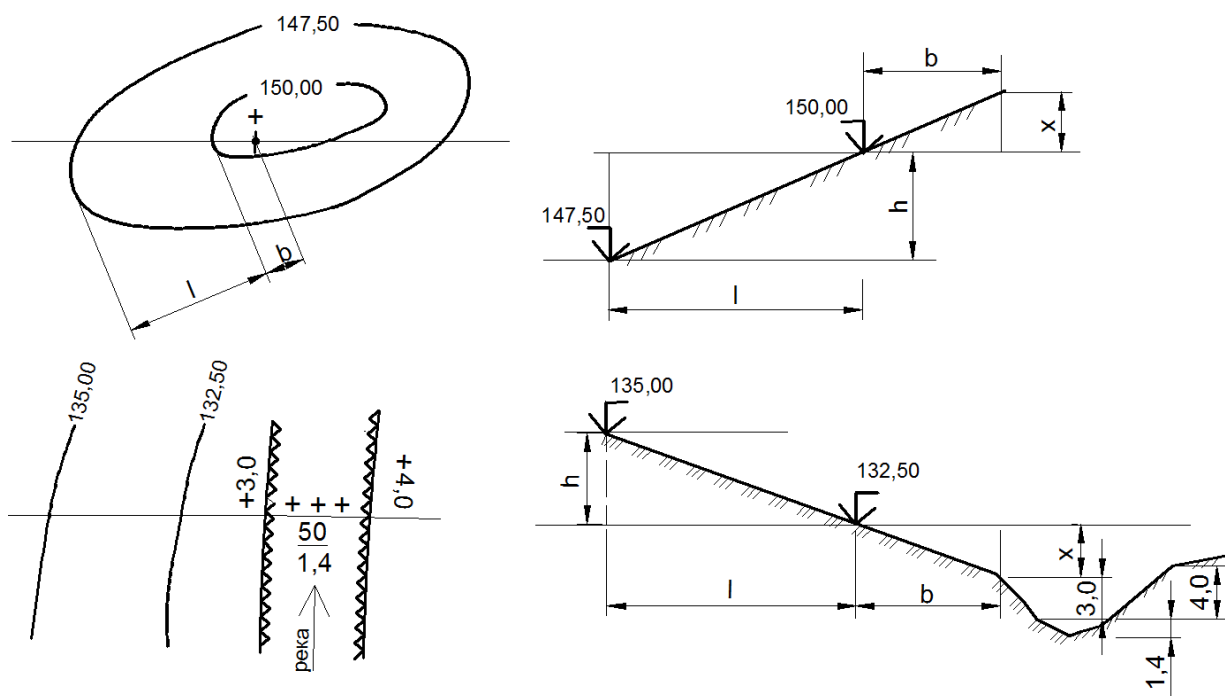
Схемы для определения отметок методом экстраполяции.
